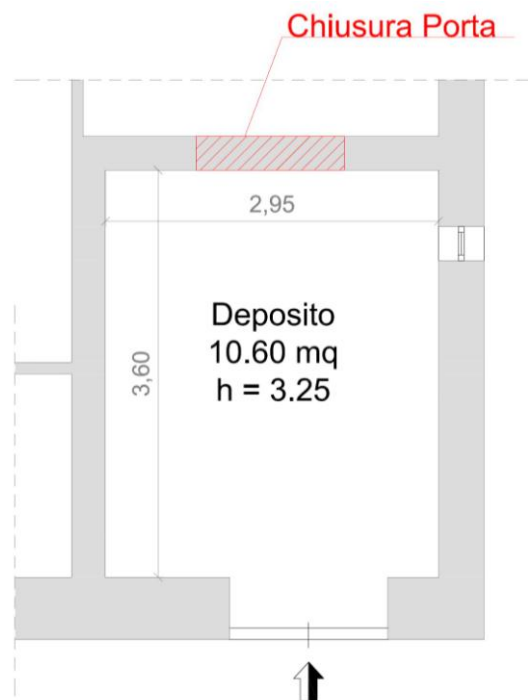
Planimetria Stato di fatto Foglio 46, p.lla 1235, sub 21.
